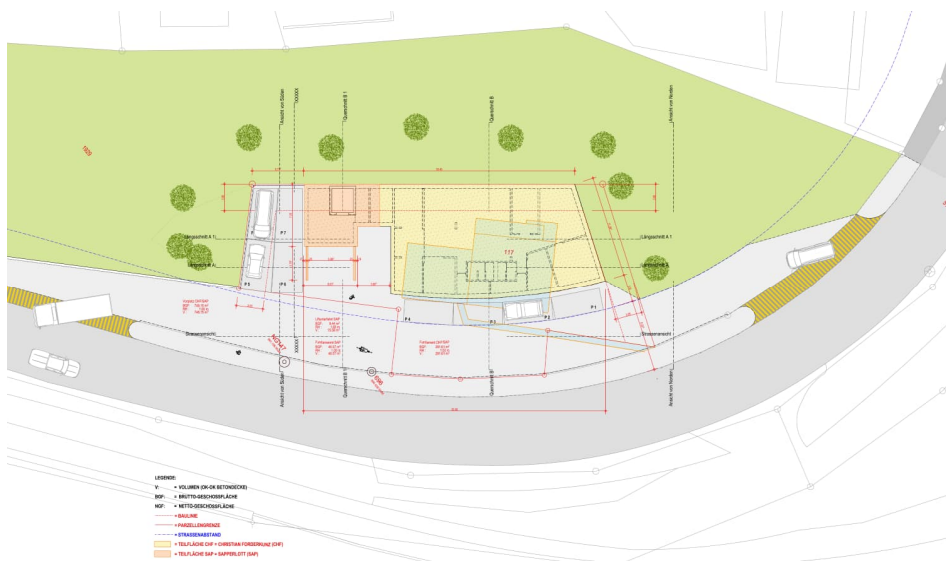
Situationsplan Fundamente, Vorprojekt (Ernst Kathriner, 2023)
